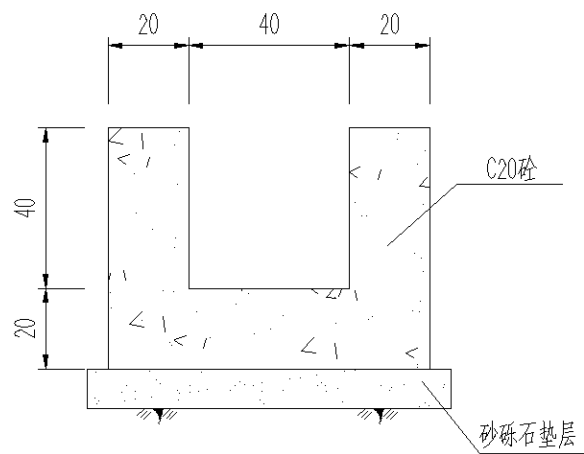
砼截水沟典型设计断面示意图（单位：cm）
